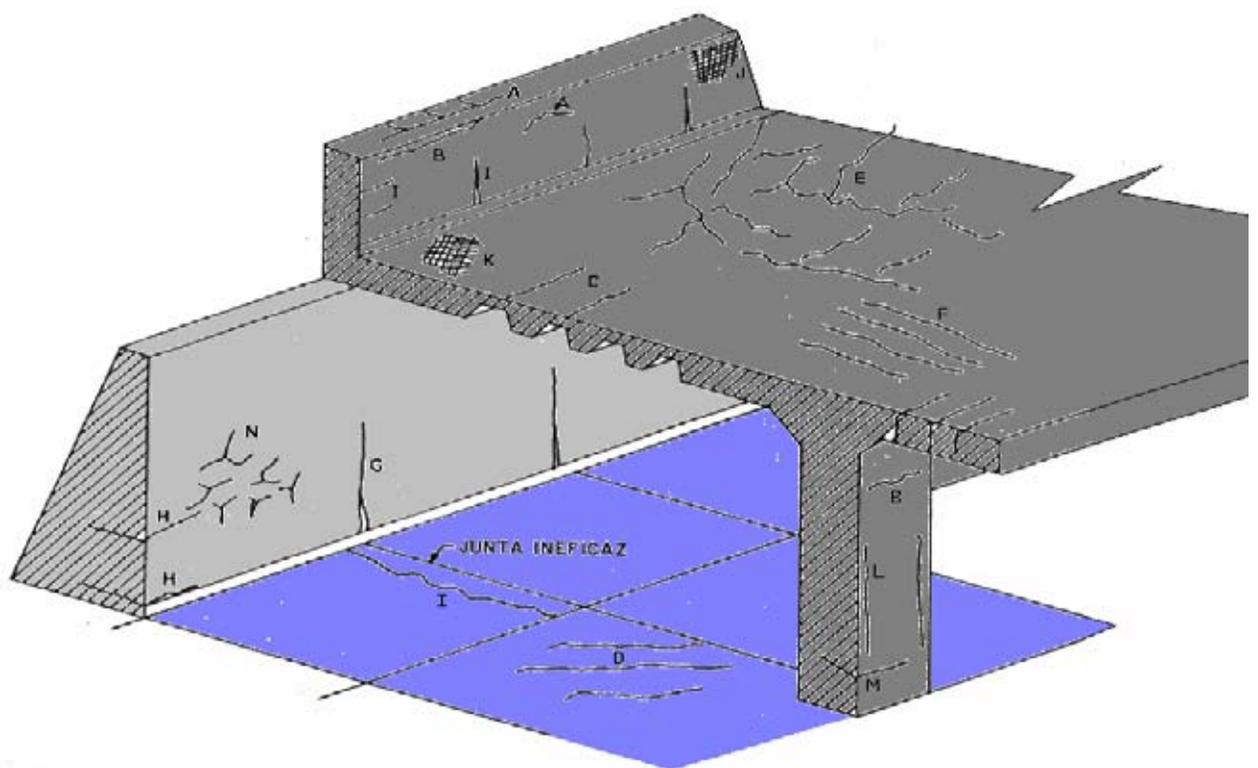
Detalle tipo de estructuras dañadas (Fuente:www.
